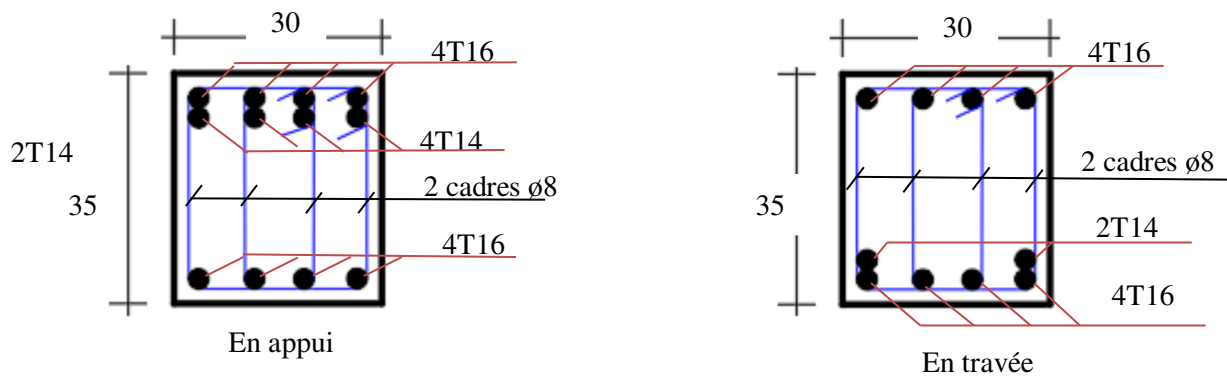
Ferrailage de la poutre principale en travée et en appui.
